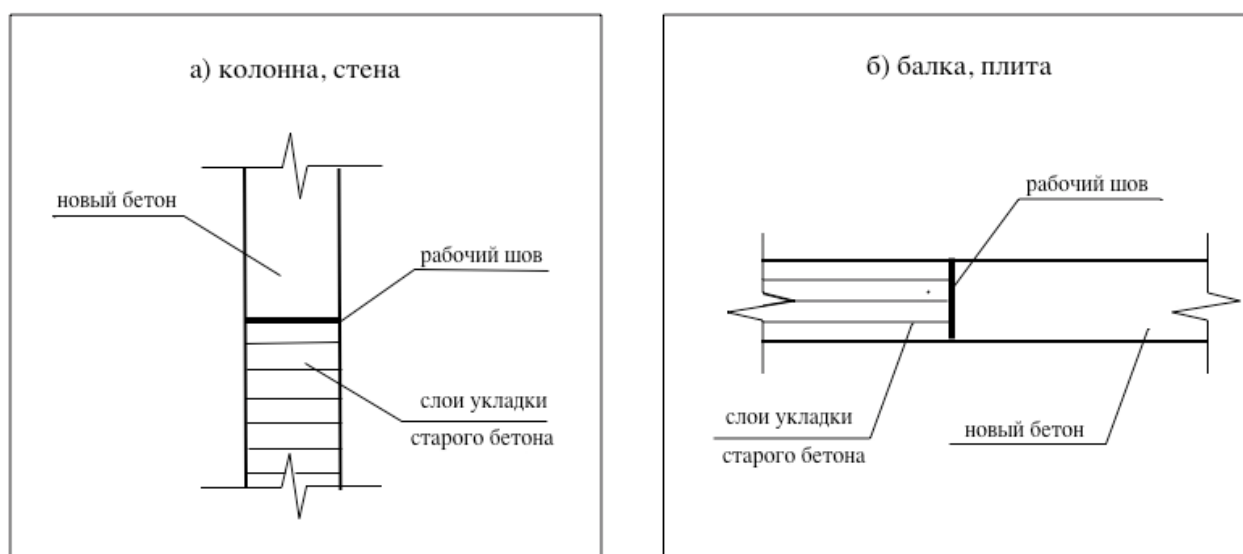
Расположение поверхности рабочего шва по отношению к слоям укладки бетона при возведении различных монолитных железобетонных конструкций
